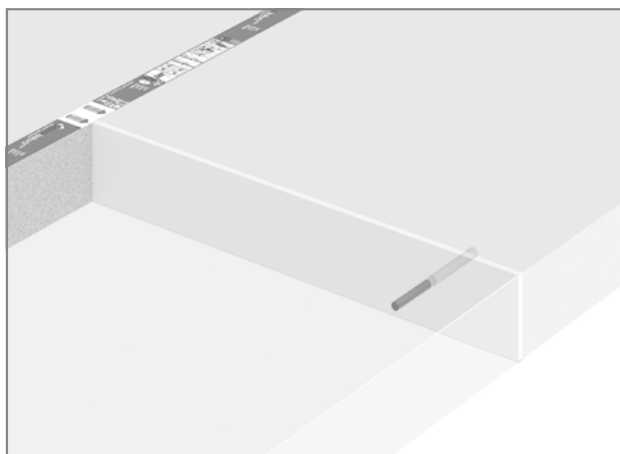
Schöck Dorn : Joints de dilatation dans les dalles de balcon
